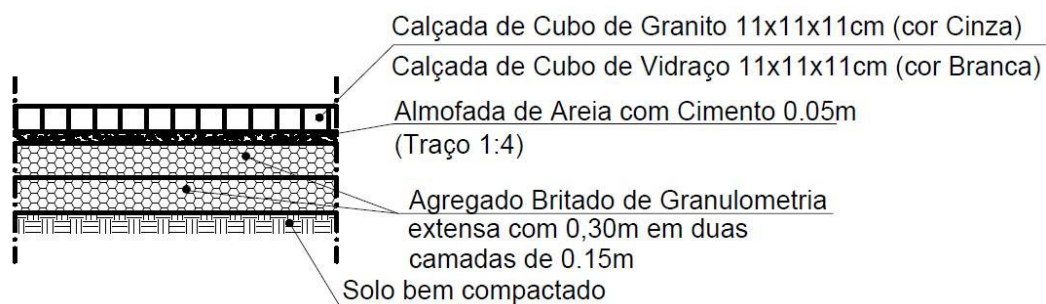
Pormenor construtivo da Rua Cláudio Nunes [76]
